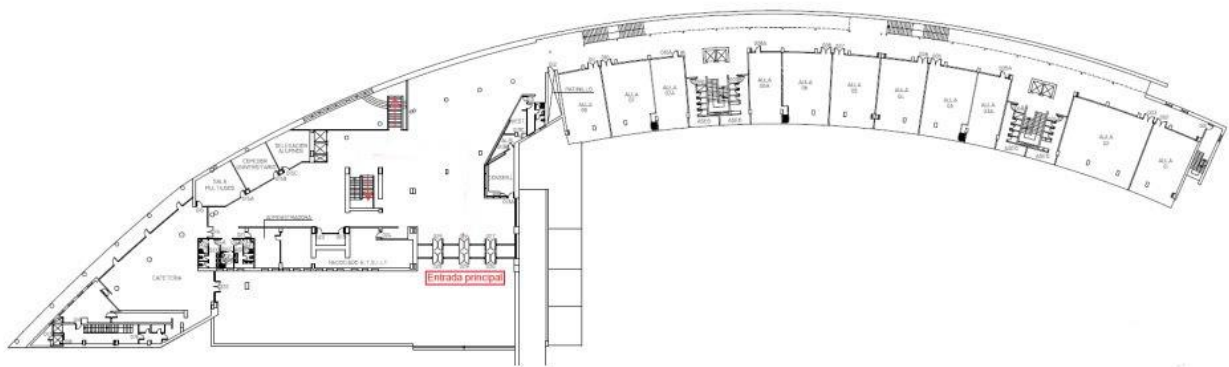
Vista vertical de la planta 0 de la ETSIIT.
